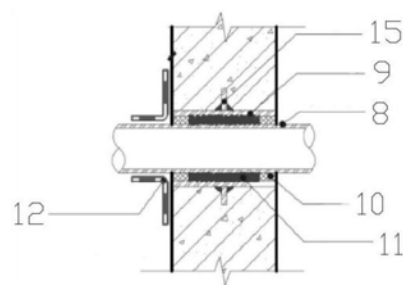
穿墙管与混凝土侧墙之间的连接结构示意图
